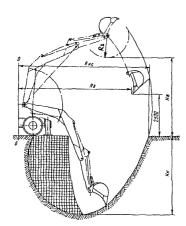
Рабочие размеры забоя полноповоротного экскаватора, оборудованного обратной лопатой
